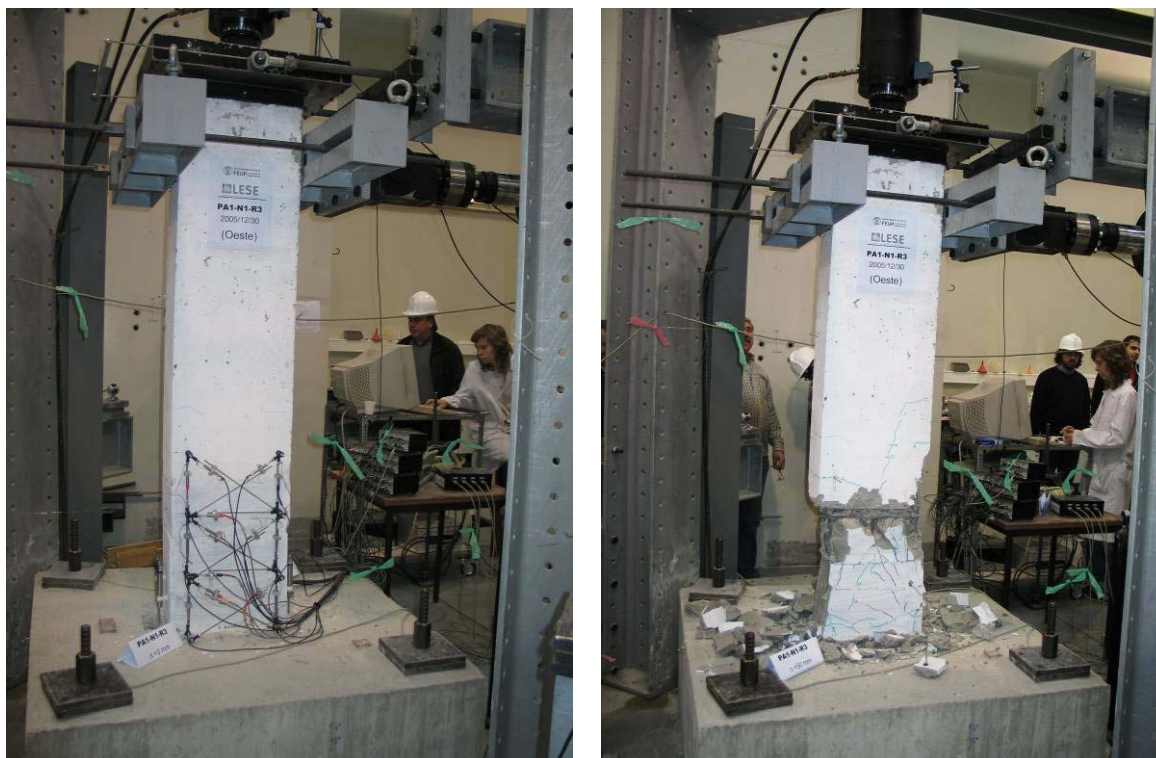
Vista do pilar no início (esquerda) e no final (direita) do ensaio.
